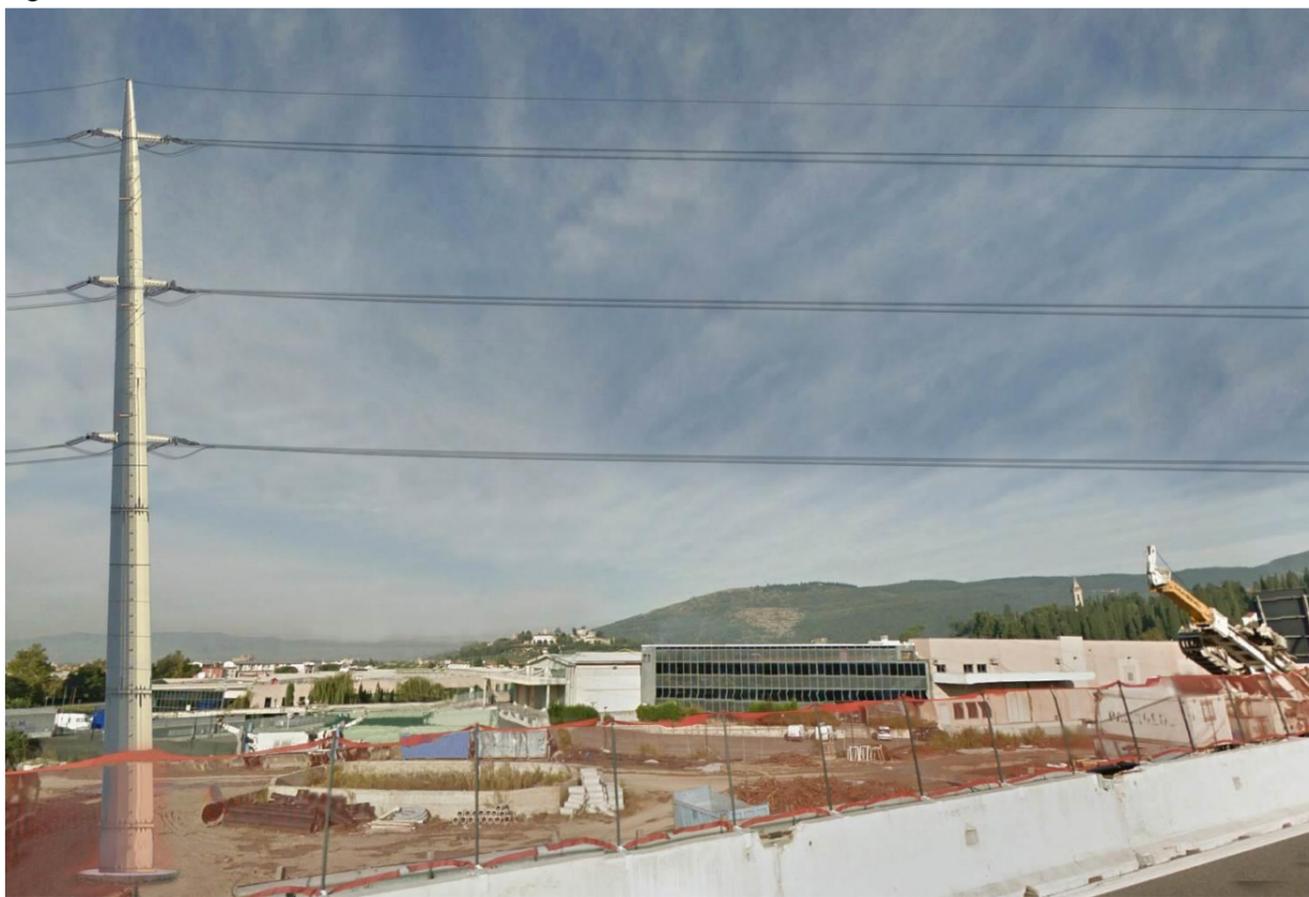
Vista dall'autostrada del Sole – PROGETTO AUTORIZZATO IN SEDE DI VIA
